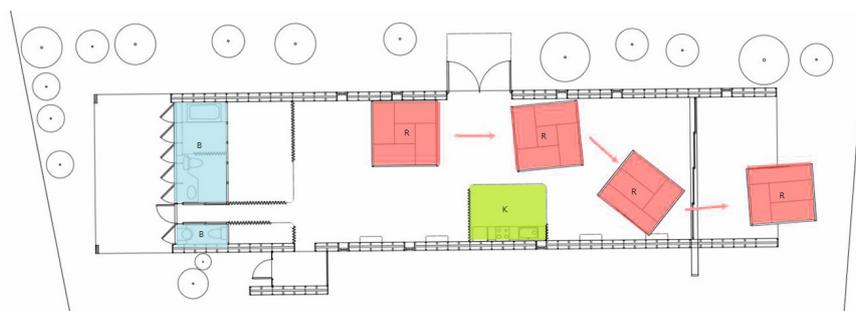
BAN, Shigeru (Saitama, 2000). *Planta de la Naked House.
